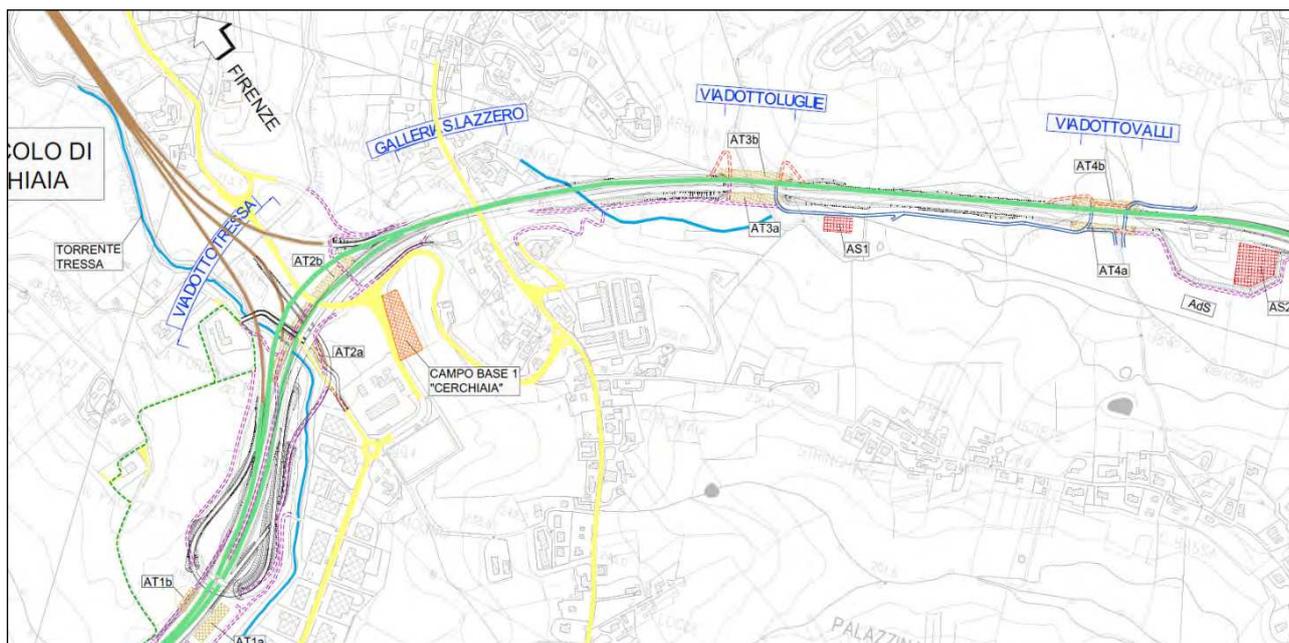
Localizzazione aree di cantiere - lato Svincolo Cerchiaia.
